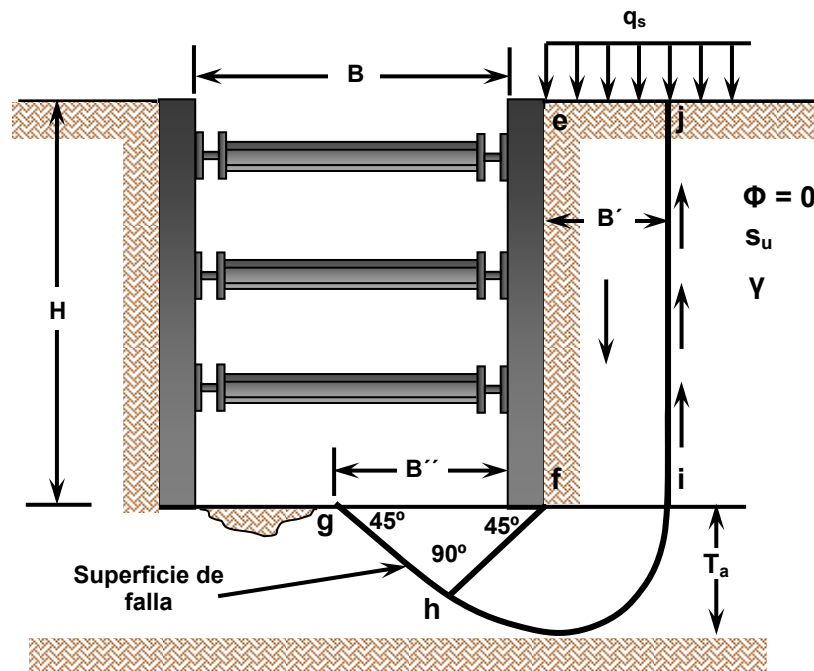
Levantamiento en corte apuntalado en suelo arcilloso.
